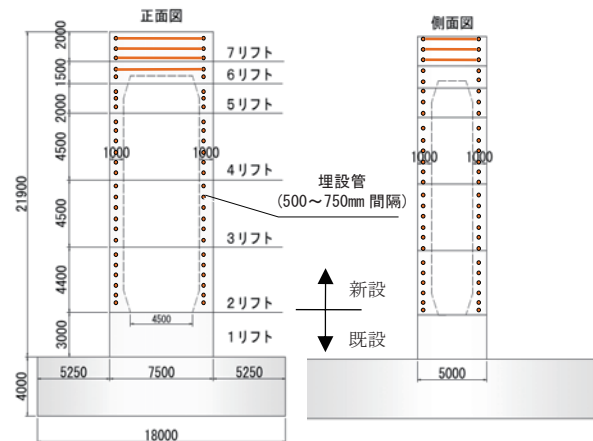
橋脚 構造一般図 (Outline of Bridge Pier)
